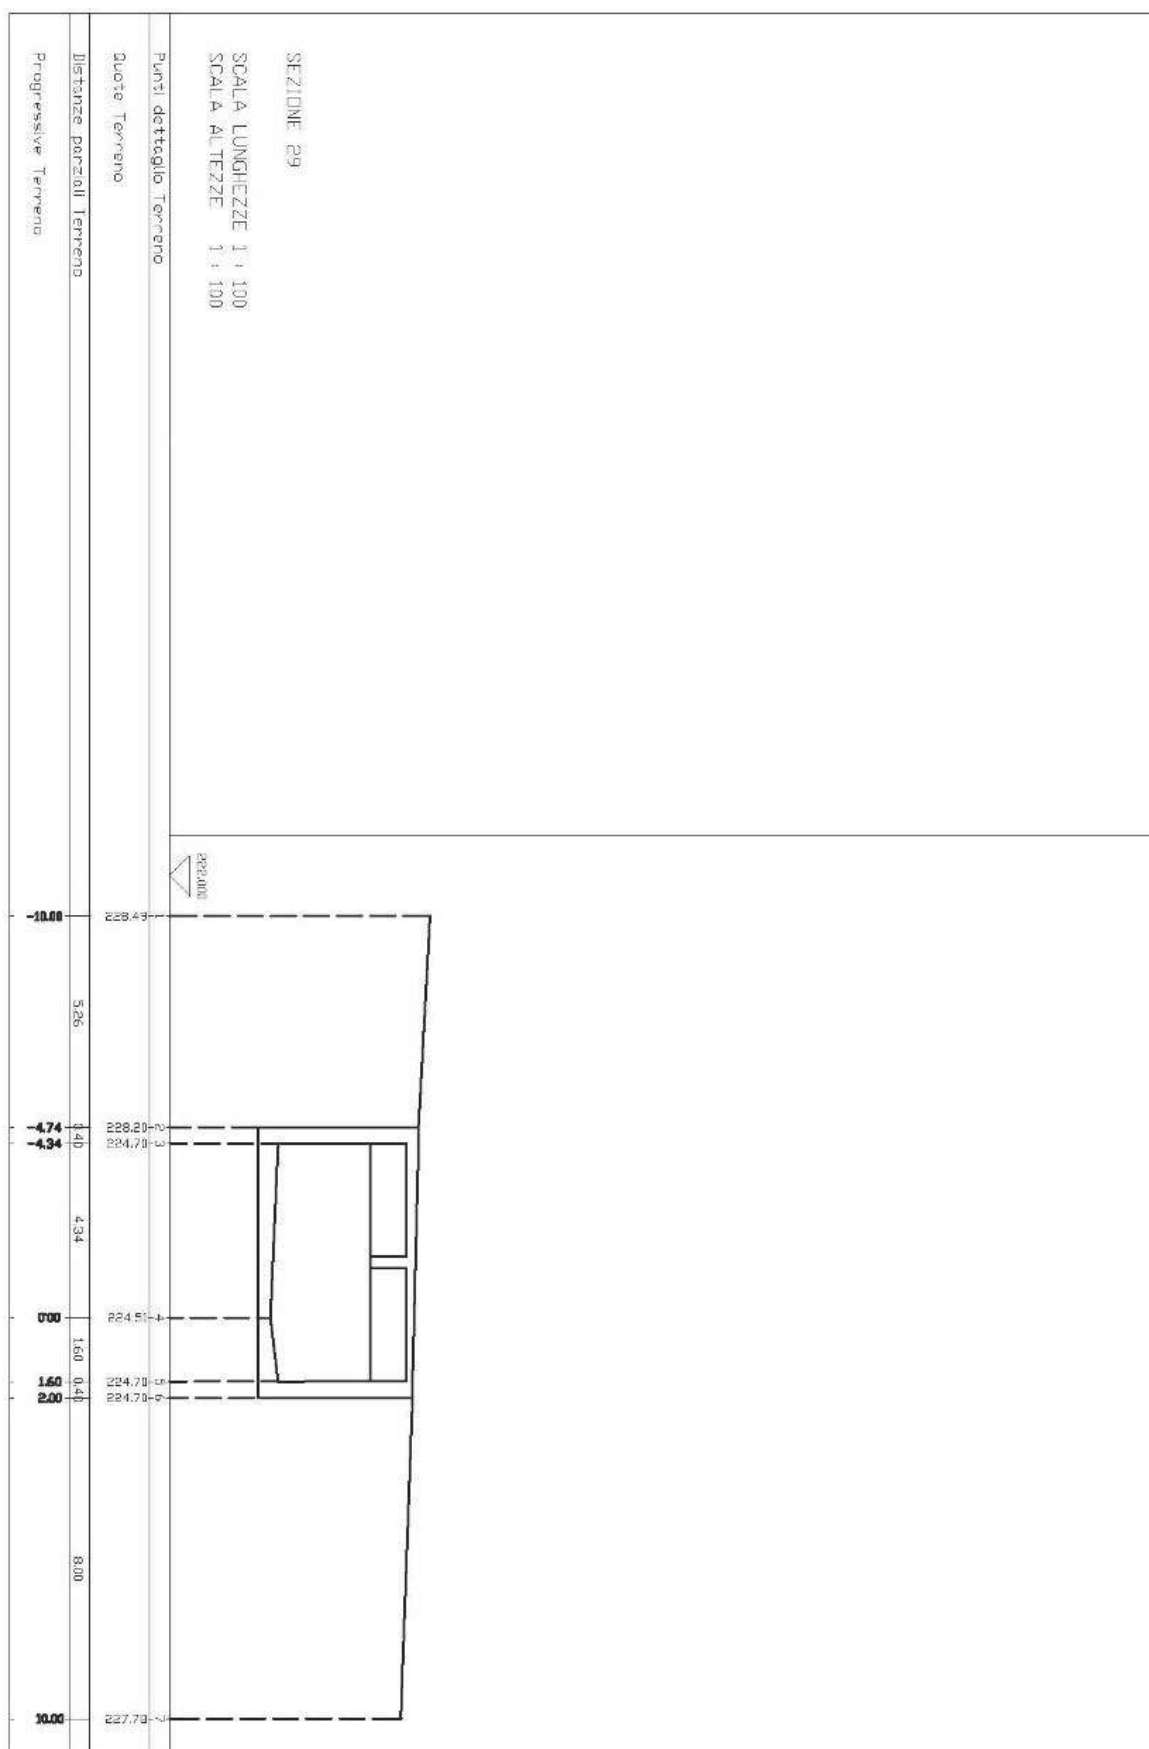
Sezione trasversale di monte dell'attraversamento stradale.
